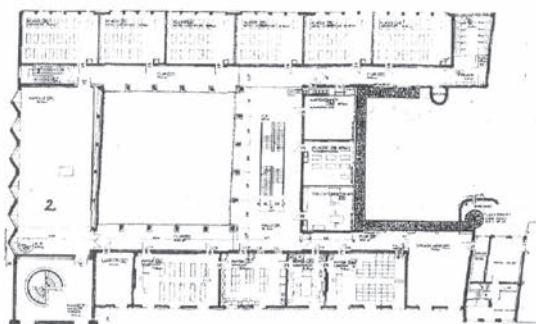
План 2-го этажа гимназии: 2. Капелла
